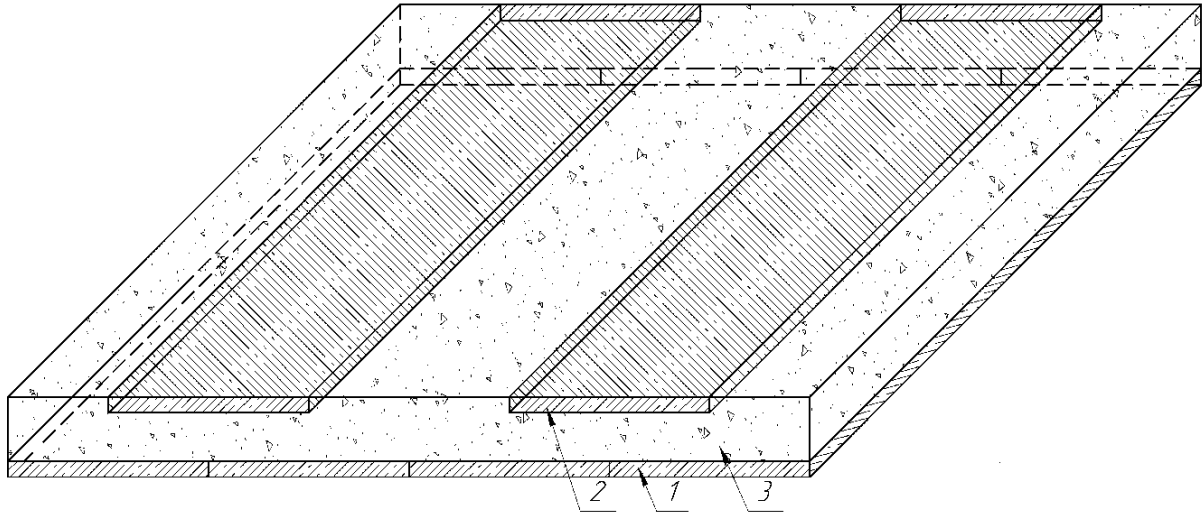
Шарувата залізобетонно-пінобетонна плита перекриття [12]:
